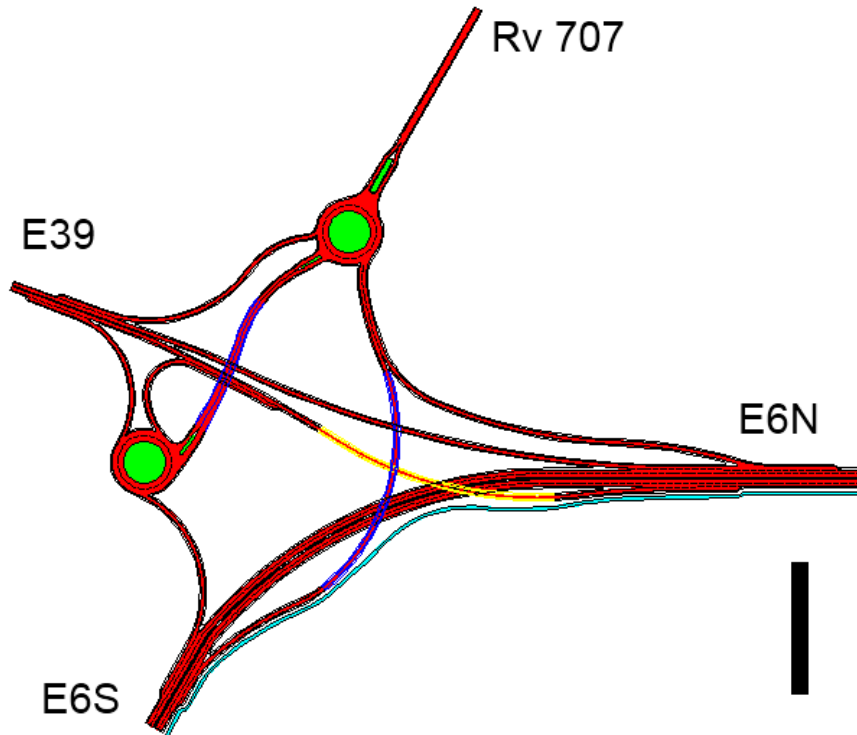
Kryssalternativ H: Rundkjøring i tre plan.
